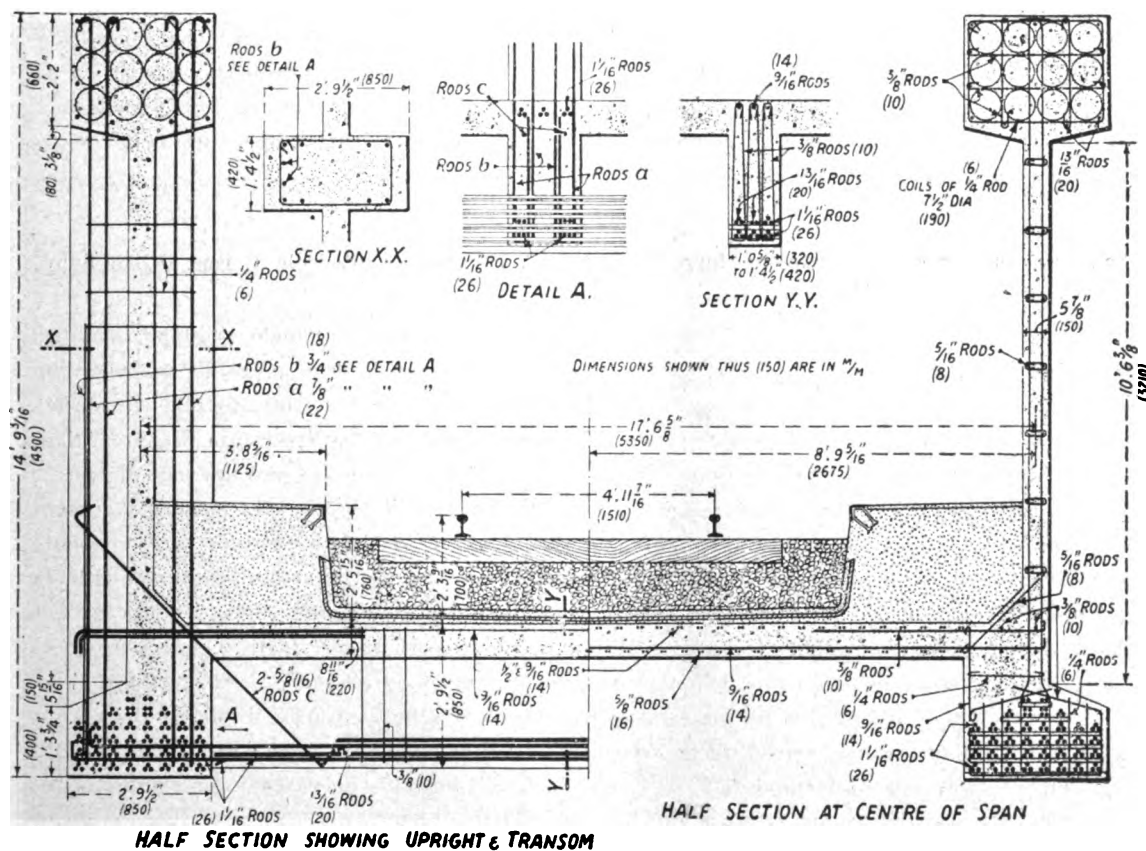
Sezione trasversale con i dettagli delle armature.
